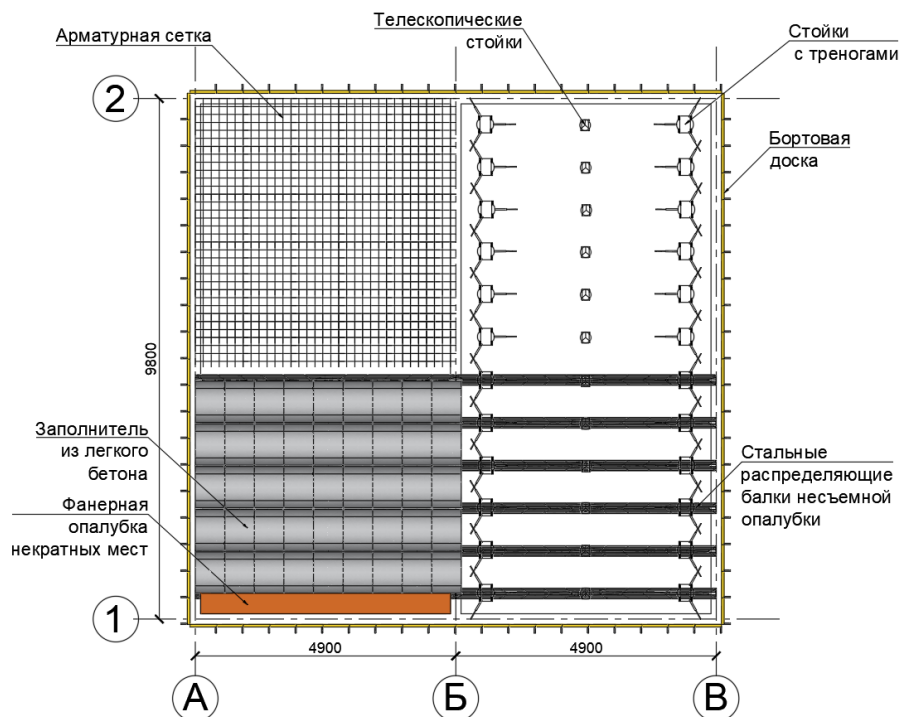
Схема устройства конструкции перекрытия с применением опалубки из профилированного настила
